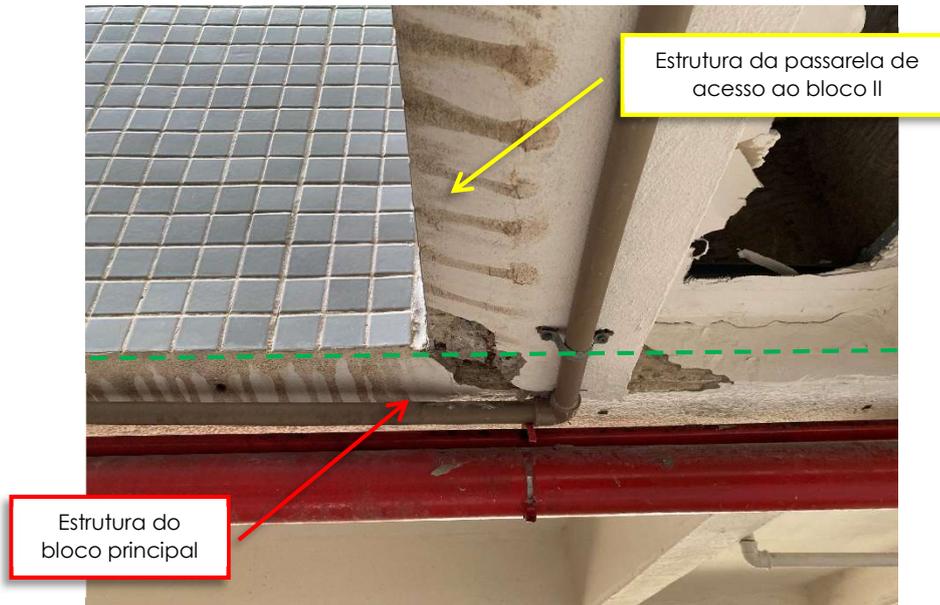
Vista externa do encontro entre as vigas das estruturas próximo a abertura nº 2.
